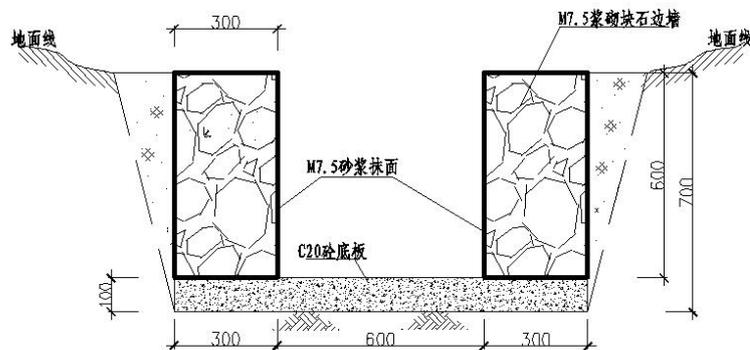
排水沟（0.6*0.6m）截面设计示意图（单位：m）
